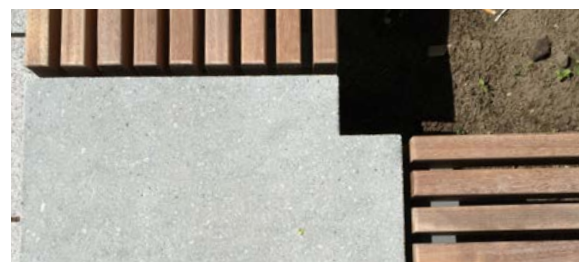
// Detail Ecke Betonbank mit Holzauflage
